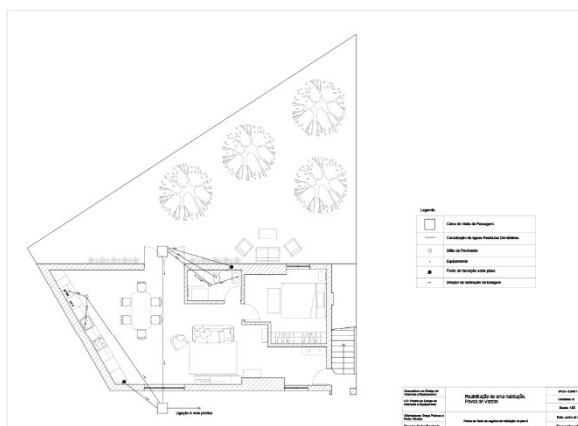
Planta de Rede de Esgotos Habitação Piso 0. Fonte: Autor.
